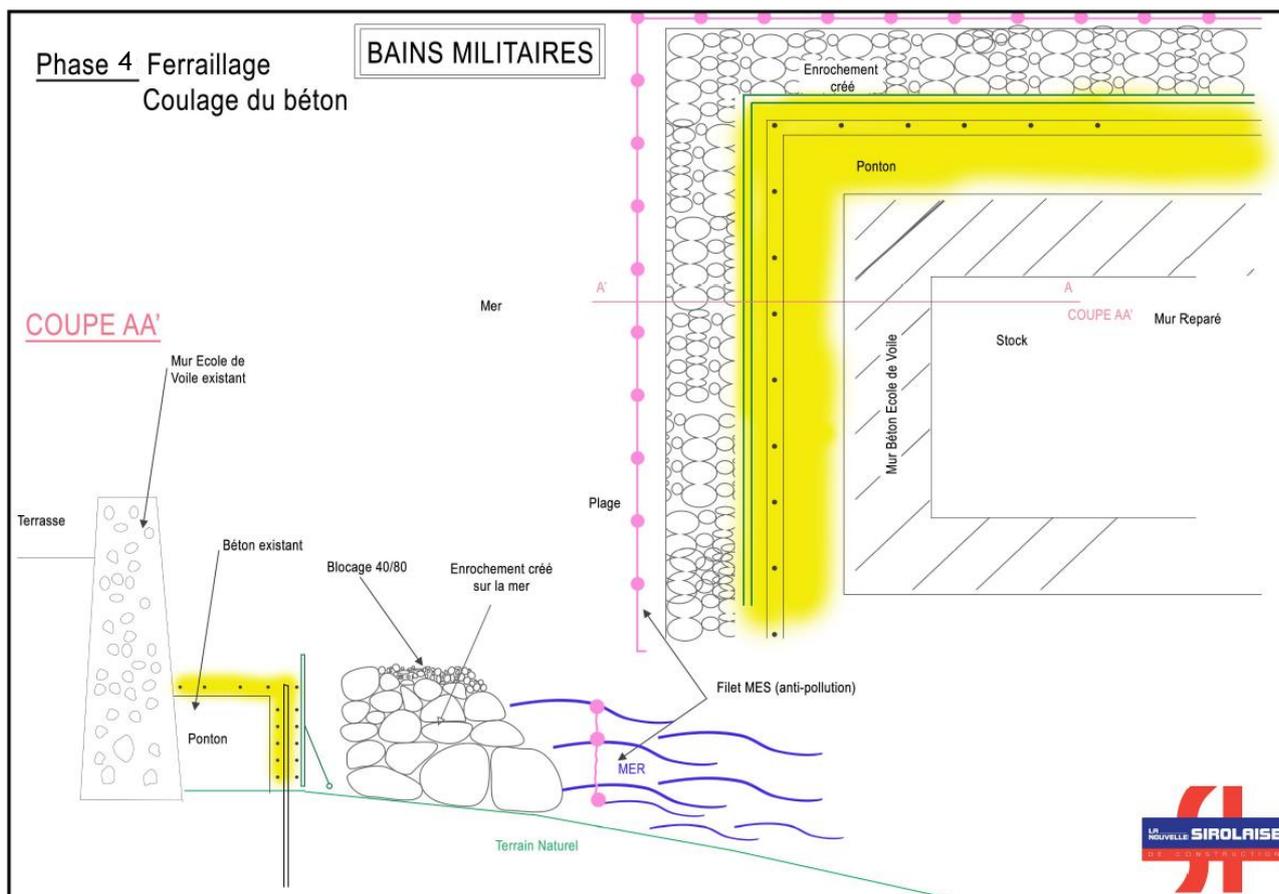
Plan de coupe des travaux de phase 2 - étape 4 (source : La Sirolaise)
